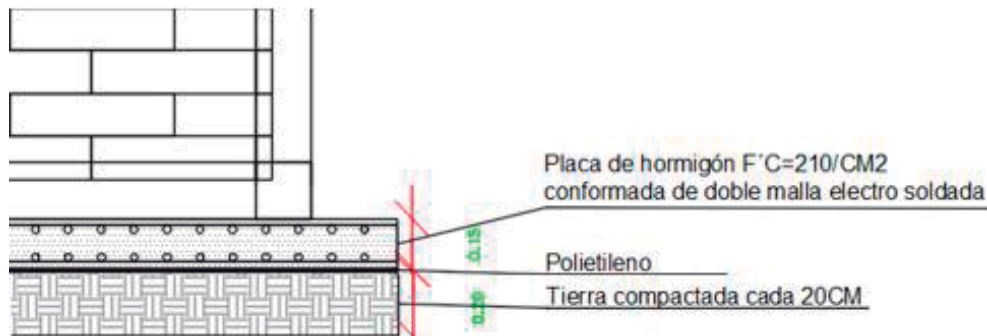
Cimentación placa de hormigón - AutoCAD, 2018
